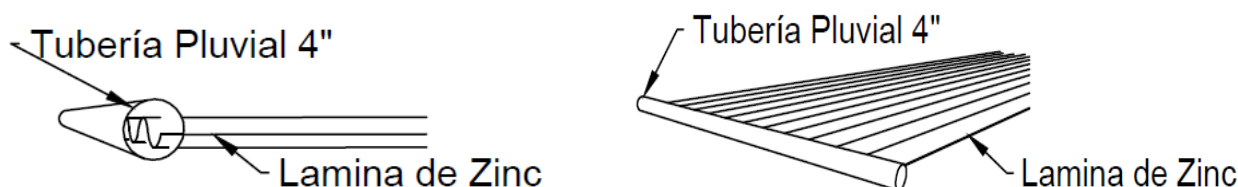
Detalle instalación tubería pluvial 4" en lámina de zinc.
